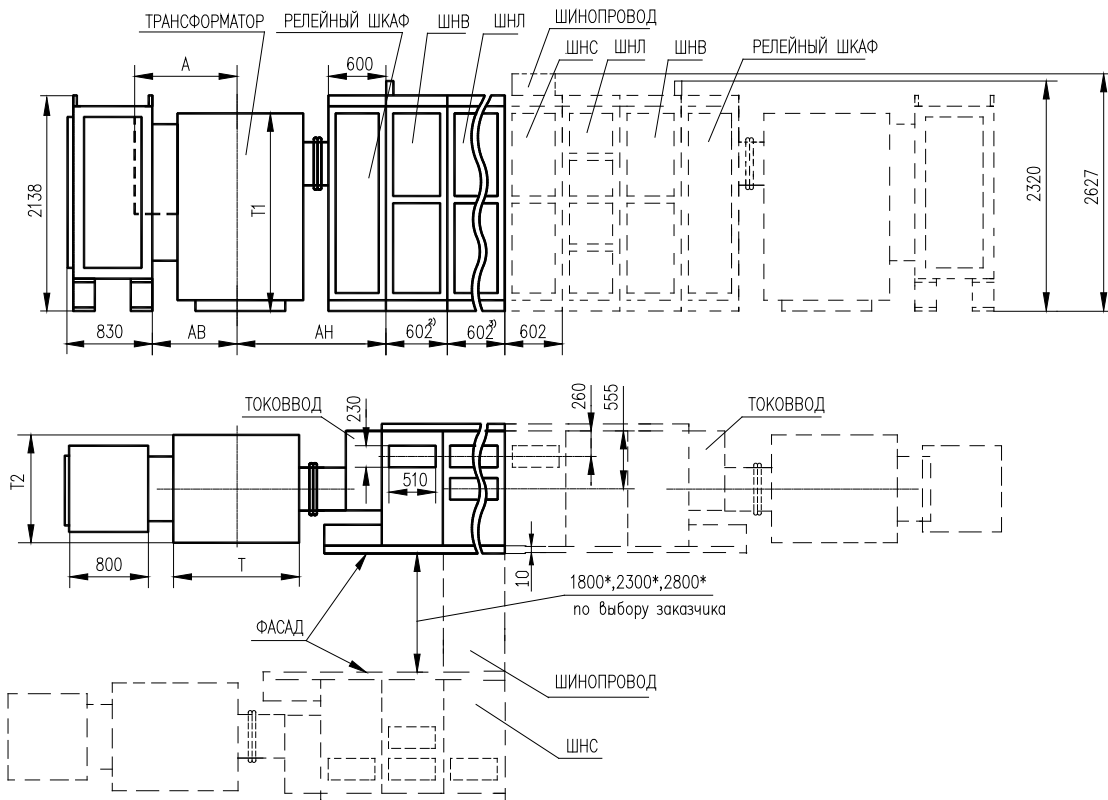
Габаритные размеры КТП 1600...2500 с Ульяновскими выключателями
